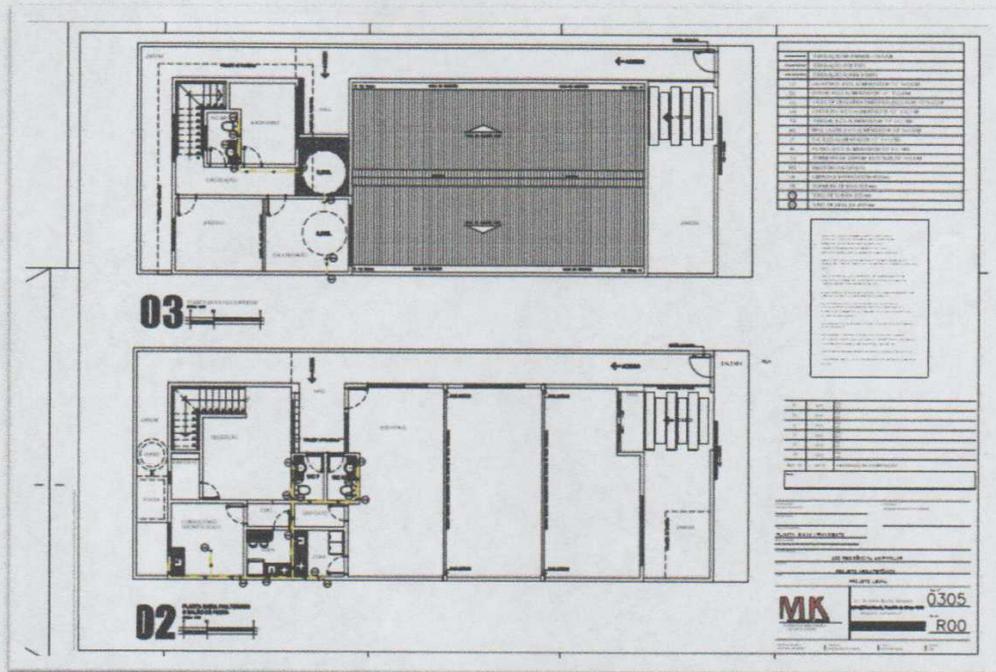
Planta baixa Pav. Superior. Planta baixa Pav. Térreo e salão de festa. Instalação predial de água fria.
